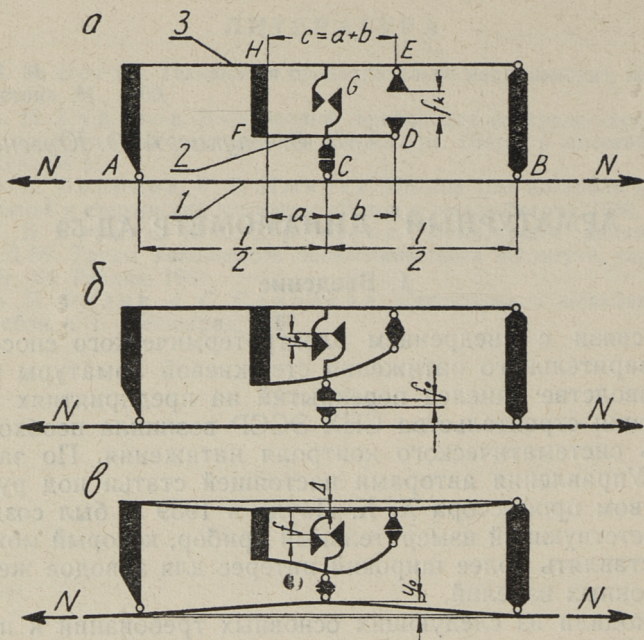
Расчетная схема арматурного динамометра АД-59. 1 — натянутый стержень, 2 — пружина, 3 — корпус.
